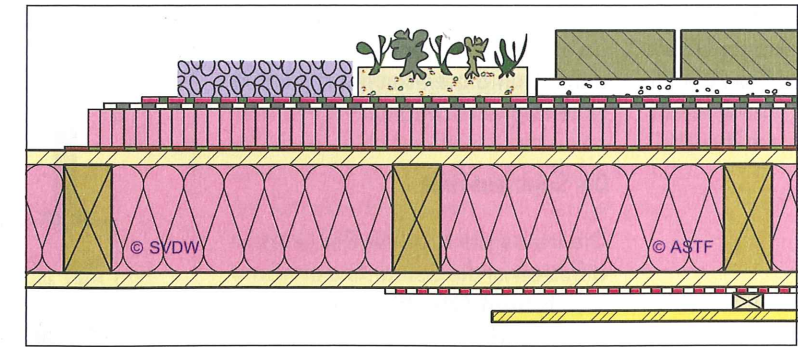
nicht belüftete Konstruktion mit der Wärmedämmung innerhalb der Tragkonstruktion, mit Zusatzdämmung.
